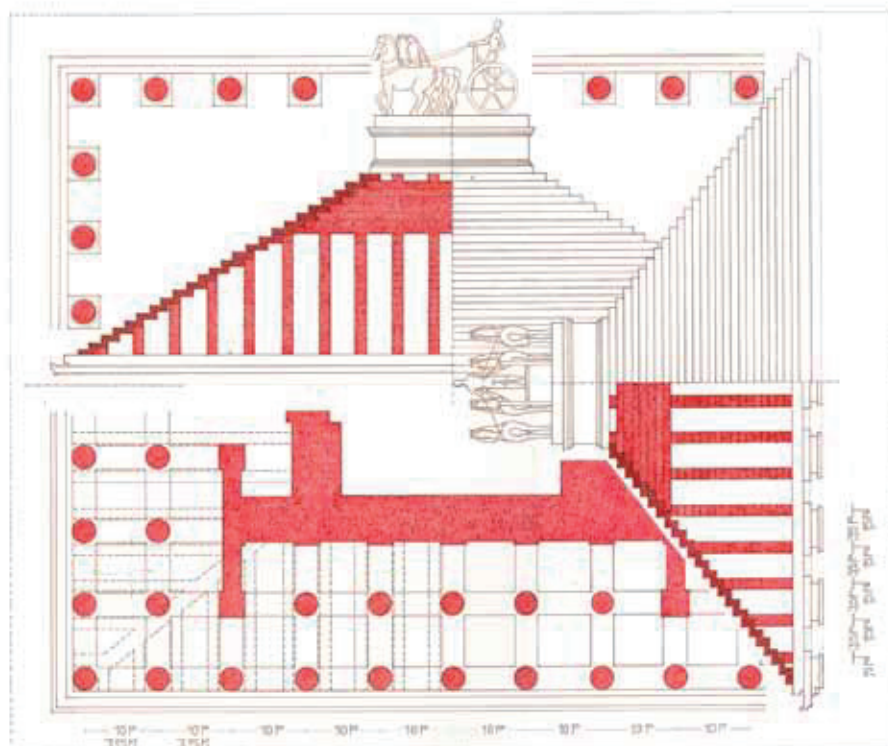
Ricostruzione congetturale del tetto del Mausoleo. La pianta dei cassettoni e le due sezioni del tetto. In basso, assonometria della trabeazione e l'inizio dei gradini della copertura. A.R. Burelli.
